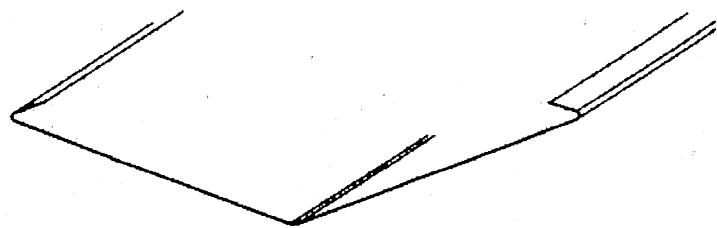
Kehlblech Ausführung mit Steg und Wasserfalz
